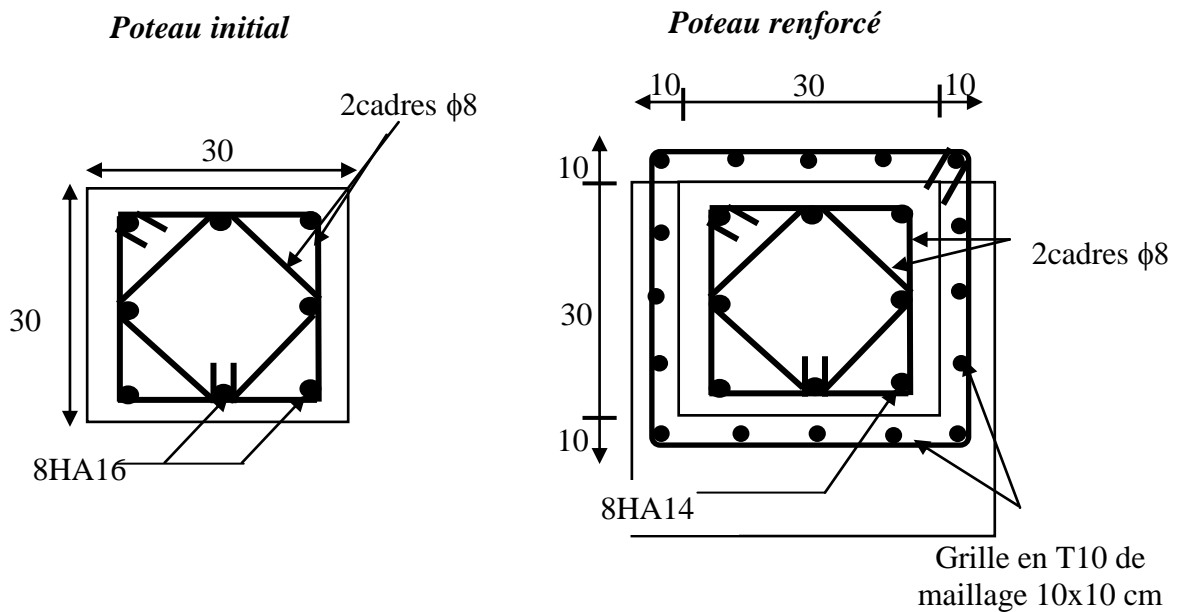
Montre l'augmentation de section d'un poteau carré et la disposition des aciers
